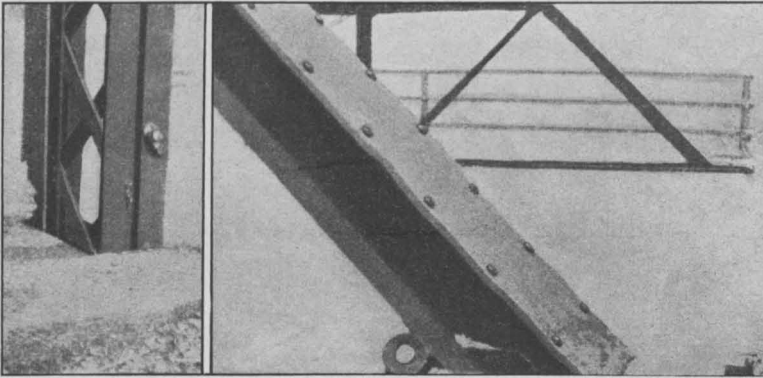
Zerstörungen an einer 15 Jahre alten Brücke durch Rostbildungen.
